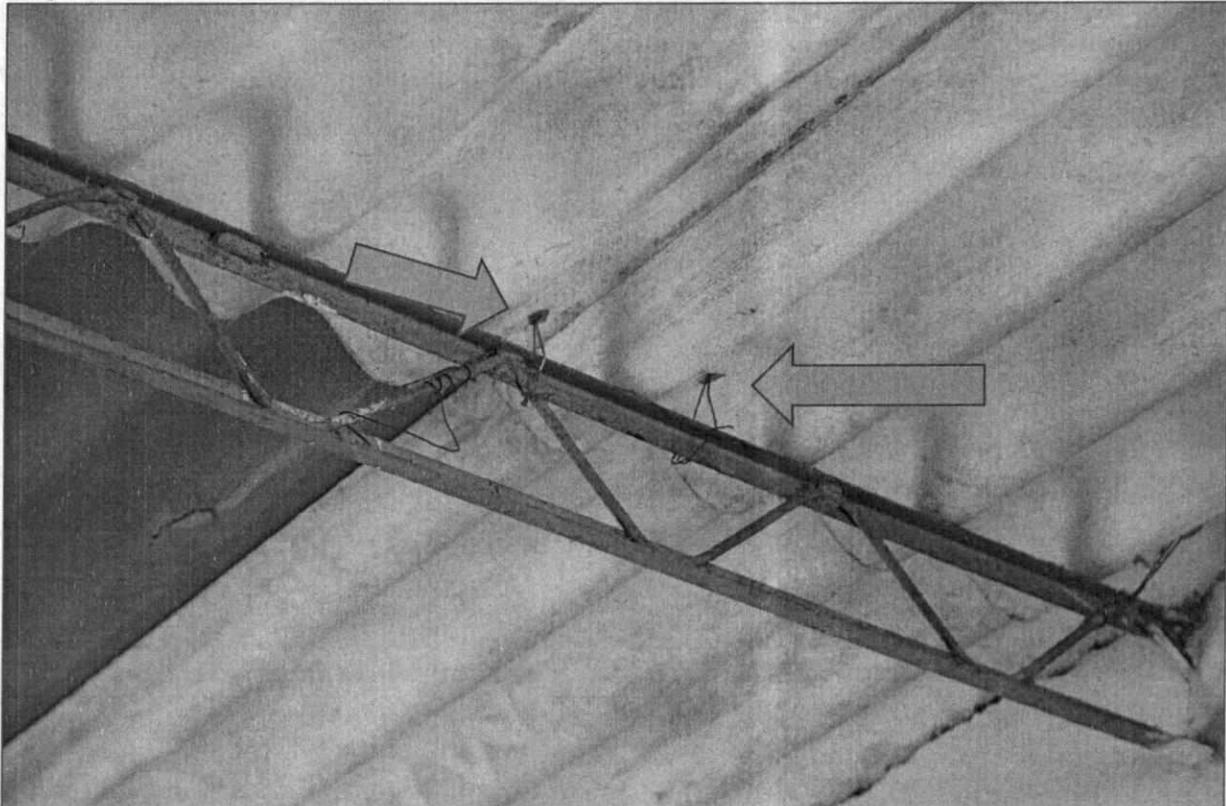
Tipo de amarres utilizados para sujeción de cubierta en asbesto-cemento
